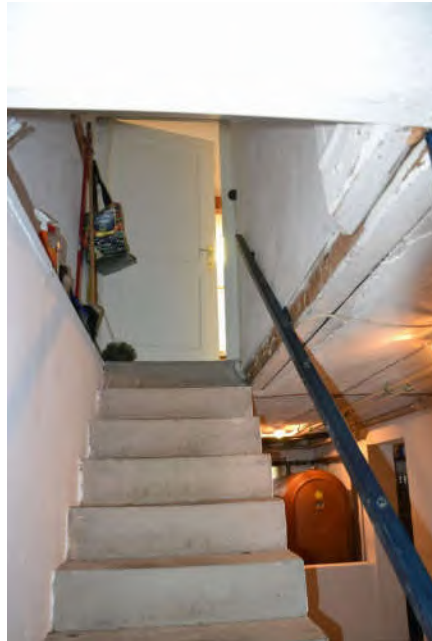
Untergeschoss Geschosstreppe zum Erdgeschoss
